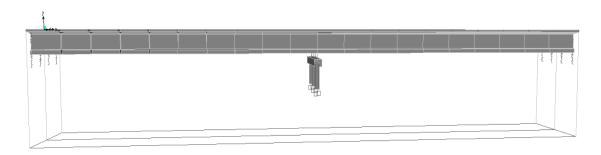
SECCION LONGITUDINAL DEL PUENTE
